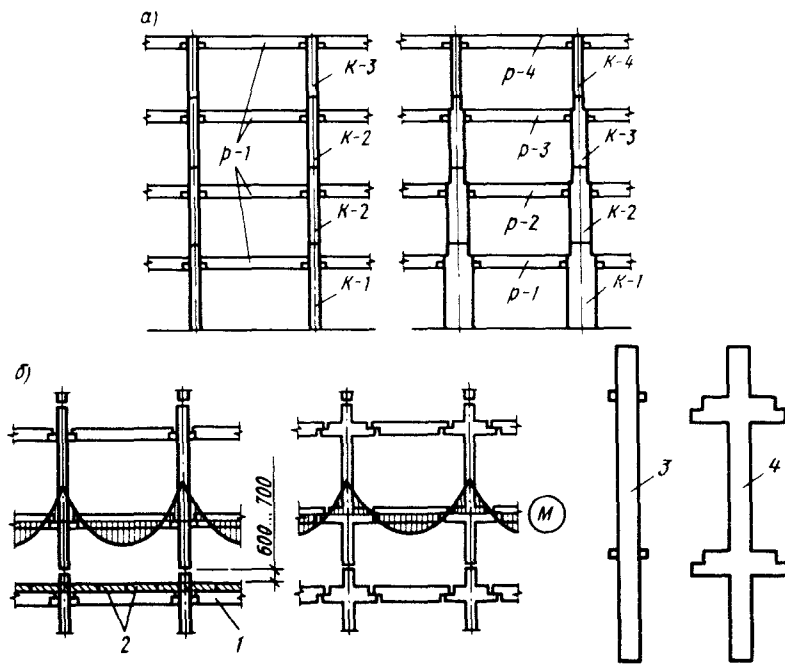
Способы членения многоэтажных рам на сборные элементы: 1 — ригели; 2 — плиты перекрытия; 3 — колонна ливневой разрезки; 4 — колонна с выступающими консолями
